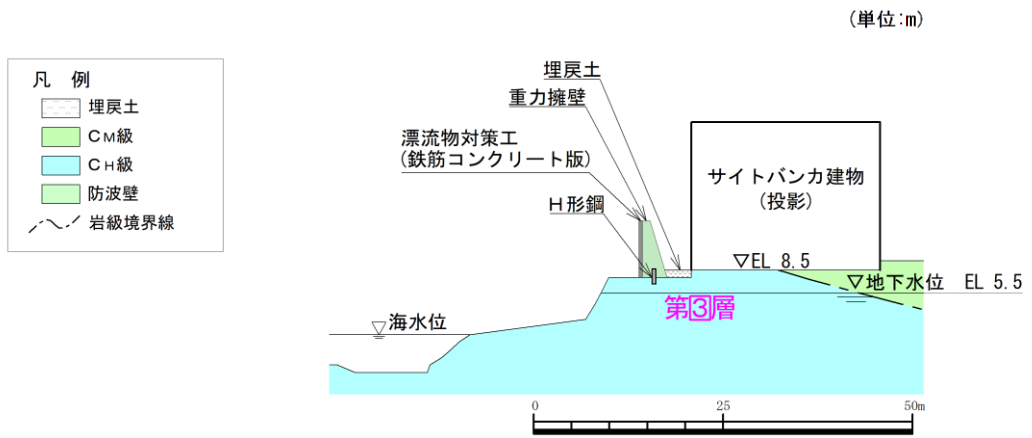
防波壁 (波返重力擁壁) の横断面図 (⑤-⑤断面)
